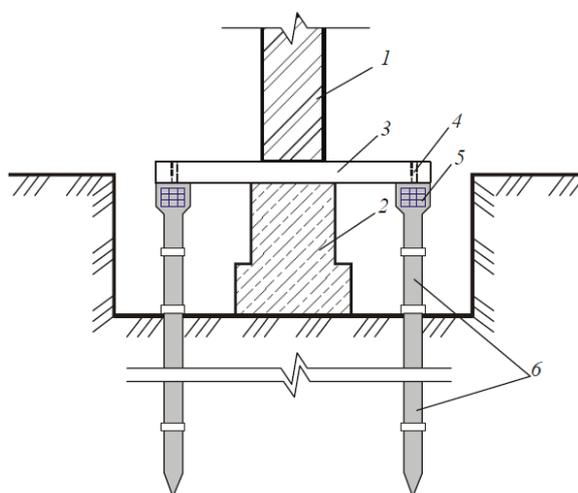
Усиление фундаментов с помощью задавливаемых металлических свай
